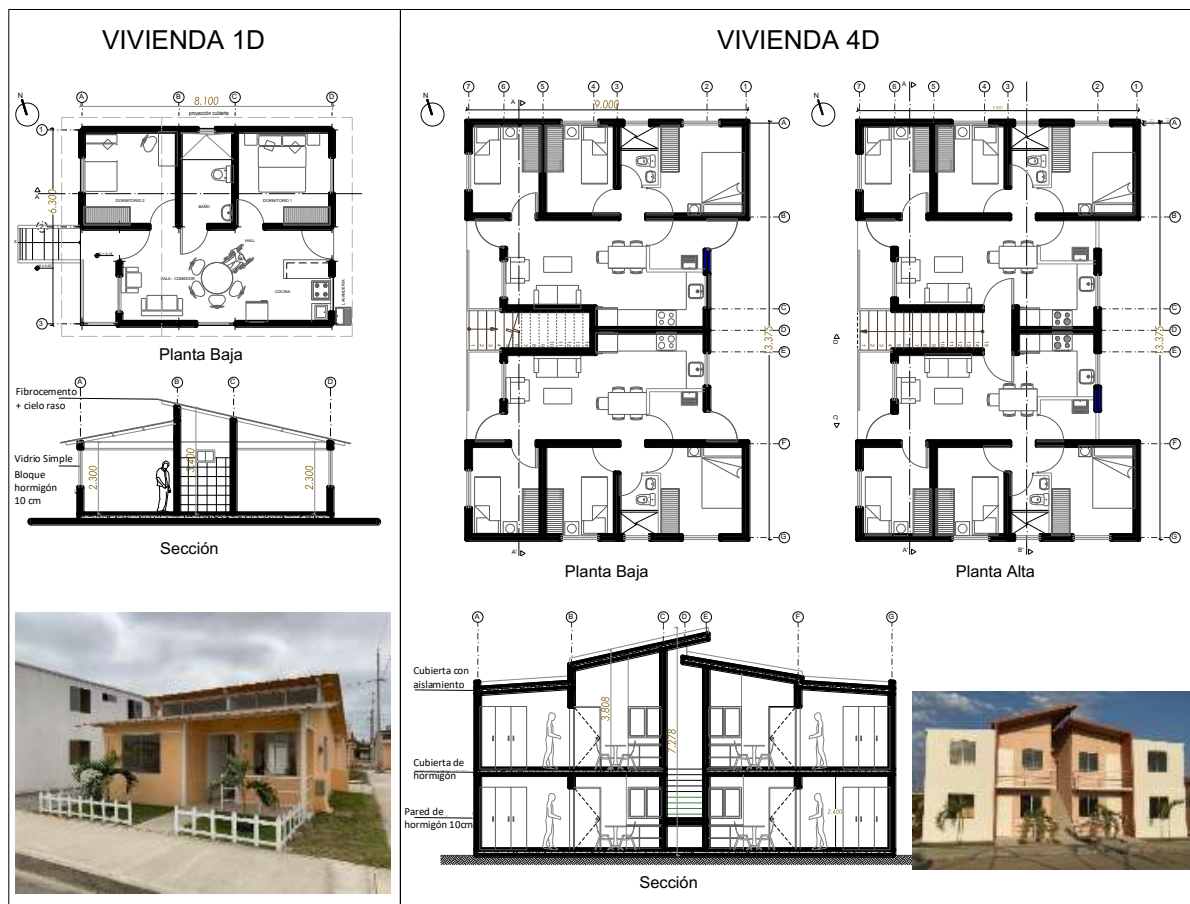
Plantas y sección arquitectónica de la V1D (izquierda) y la V4D (derecha).
